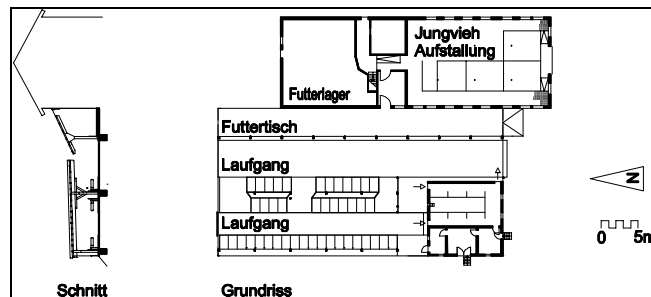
Grundriss und Schnitt des Betriebes Haneberg, Kempten.
